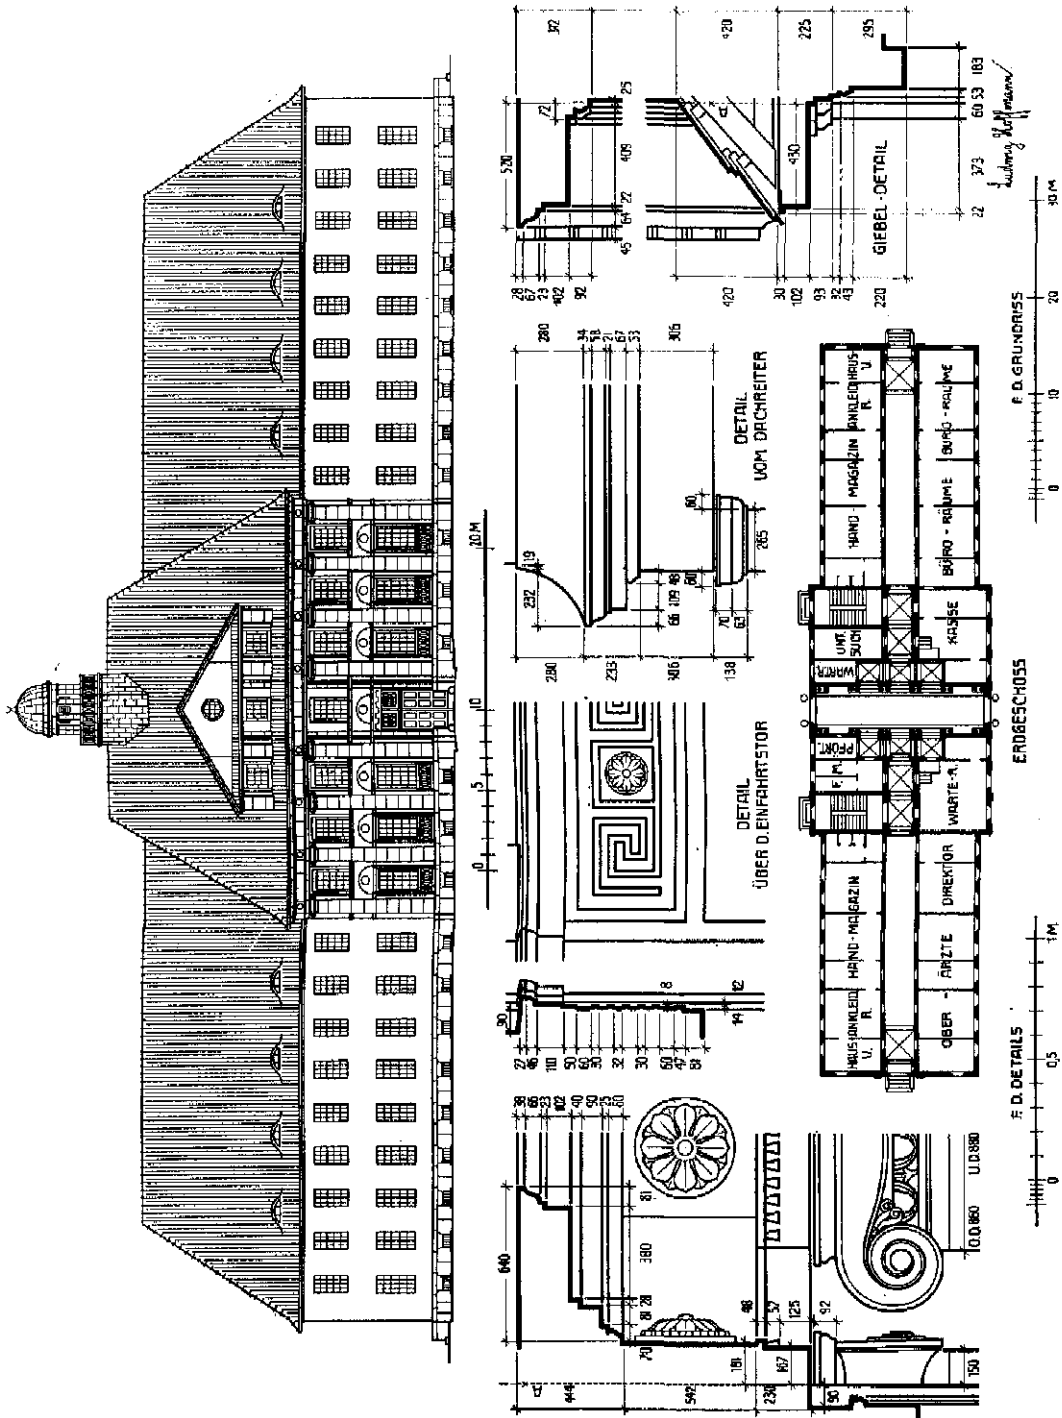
Verwaltungsgebäude. Fassade, Grundriß und Details
